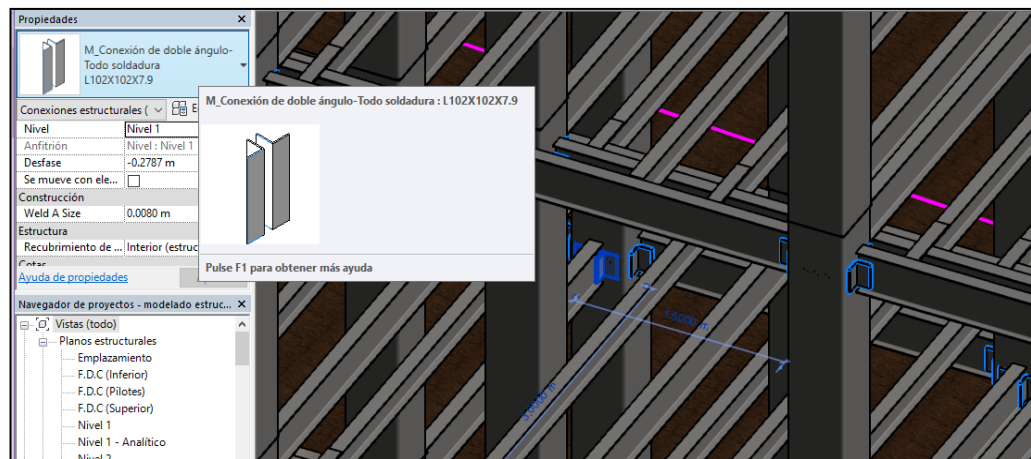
Vista de propiedades de conexiones soldadas de doble ángulo estructural de la cubierta
